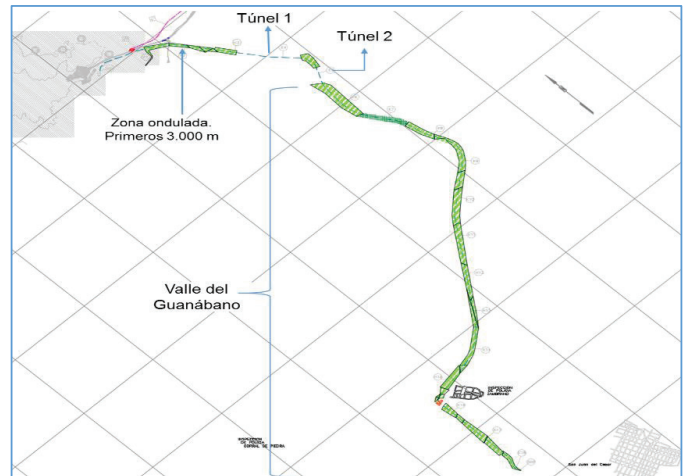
Planta del trazado de conducción San Juan del Cesar.
